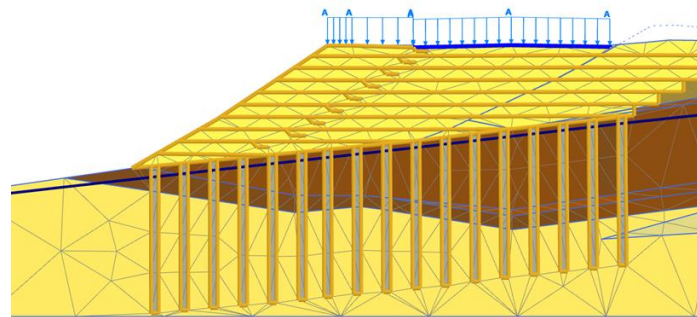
Модель расчетной осадки армонасыпи и грунтового основания с щебеночными сваями в виде сети КЭ.
